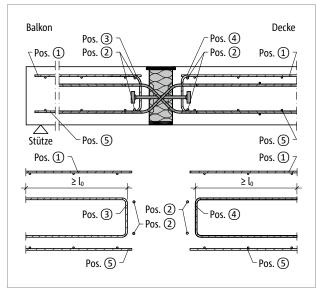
Schöck Isokorb® T Typ QP: Bauseitige Bewehrung
